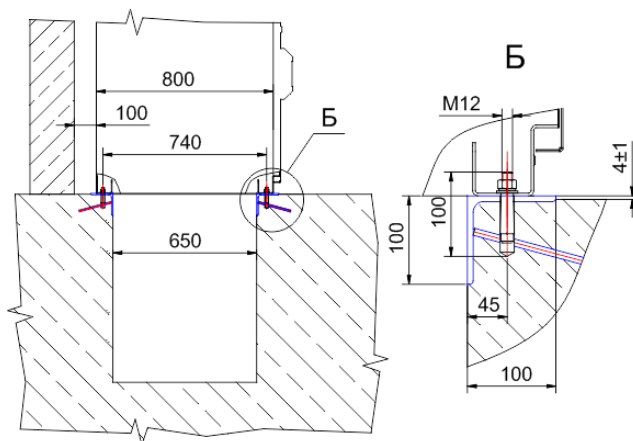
Пример конструкции фундаментной рамы и кабельного канала, выполненного из уголков. Крепление анкерными болтами М12.
